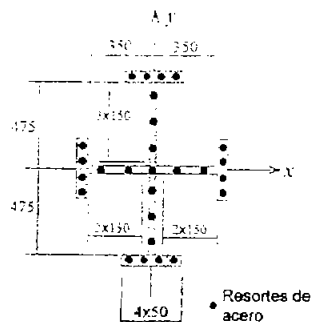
Sección descompuesta: resortes múltiples para la columna metálica (Kang-Ning, 1996)
